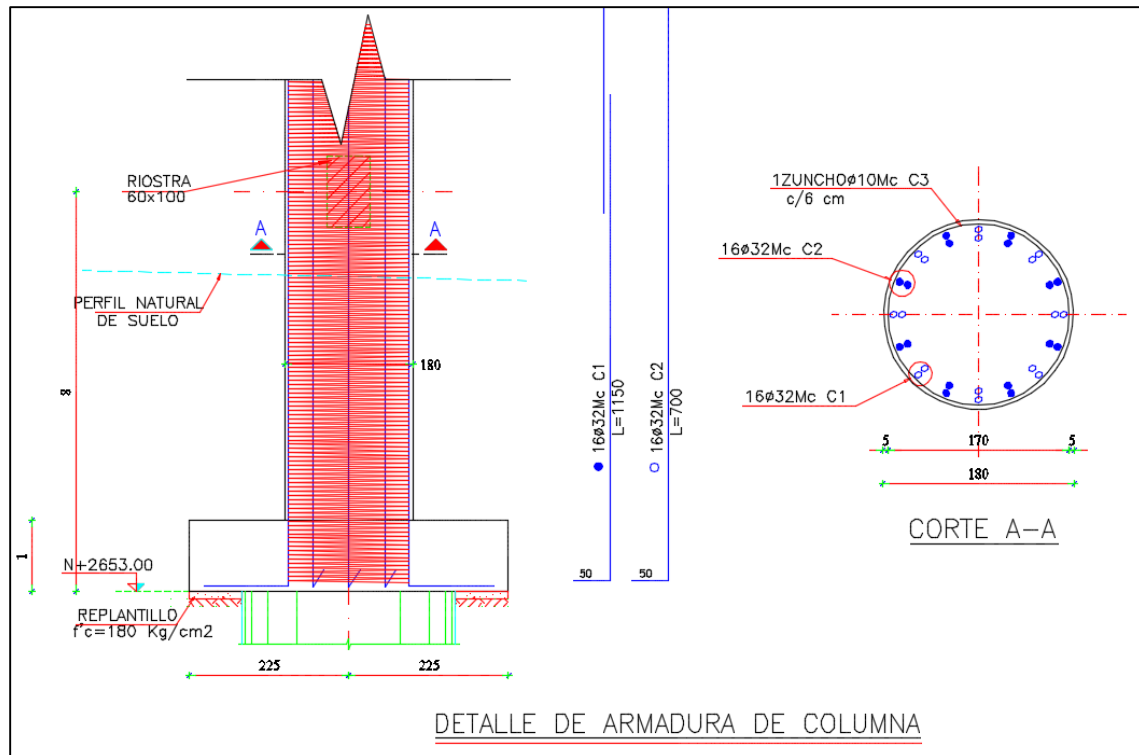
Detalle de armadura tipo de las pilas P1 y P2 Tramo B2B3.
